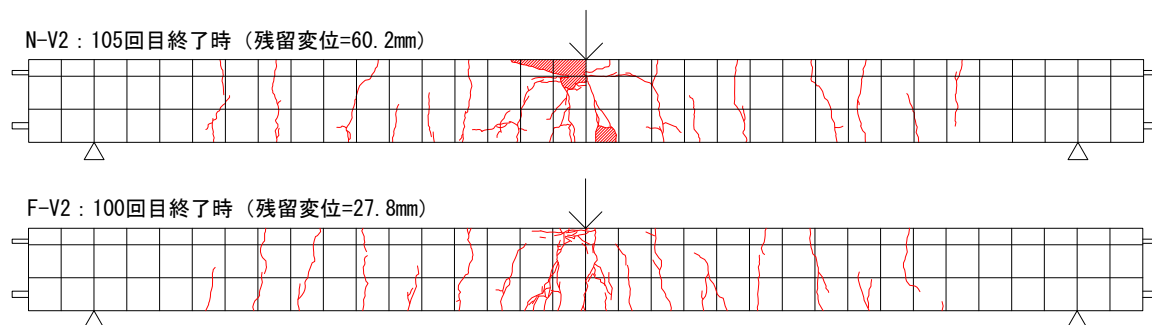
ひび割れ発生状況 (V=2m/s)
